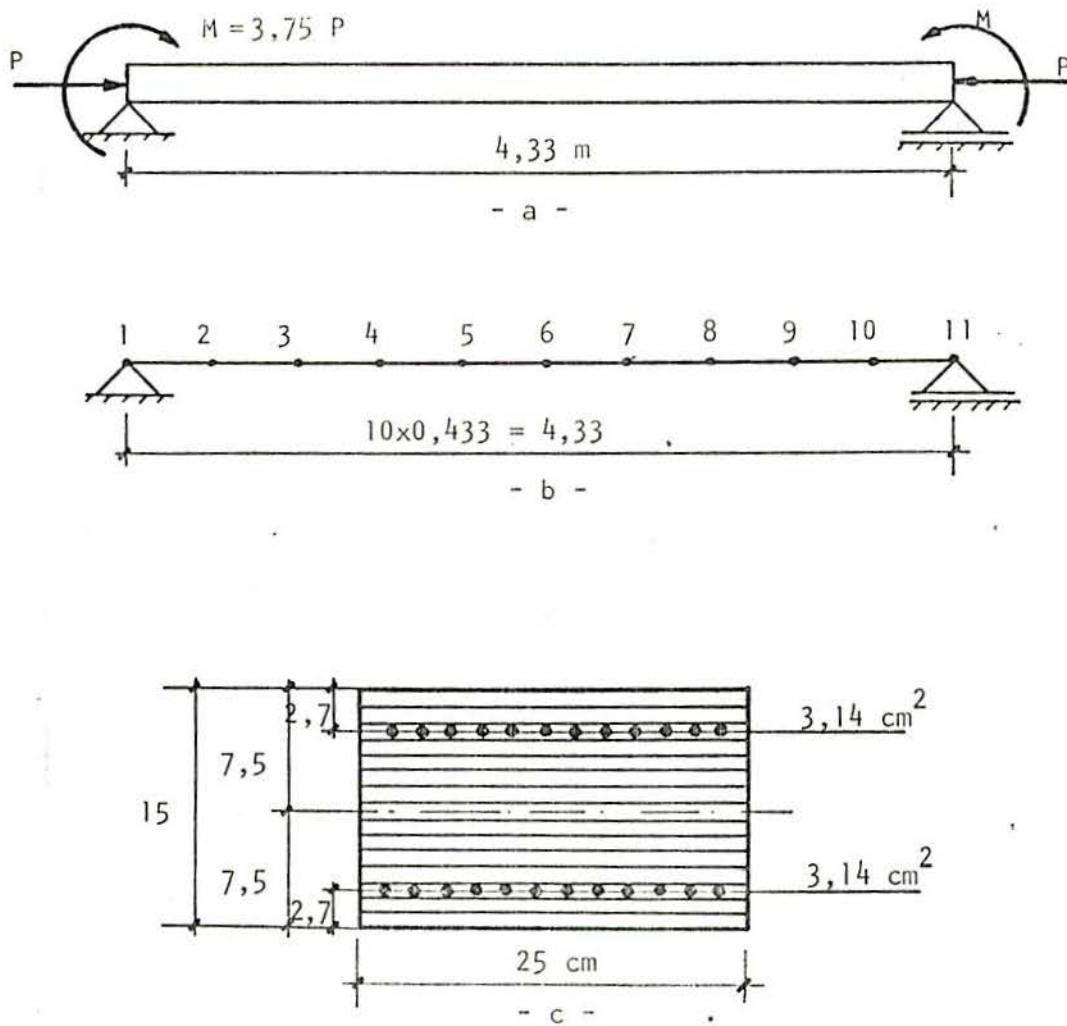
a) Viga-coluna; b) discretização; c) seção transversal.
